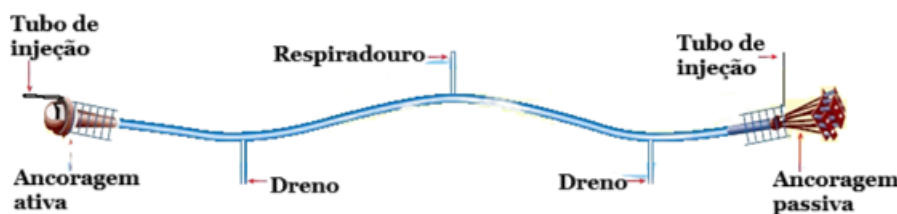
Aplicação de pré-esforço por pós-tensão. [7] (adaptado).
